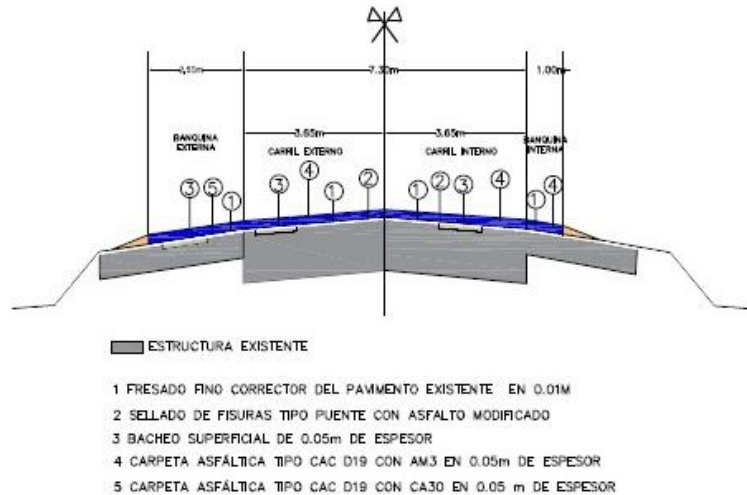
Perfil Tipo de Pavimento del Tramo II de rehabilitación en R.P. N° 2 – Calzada Descendente
